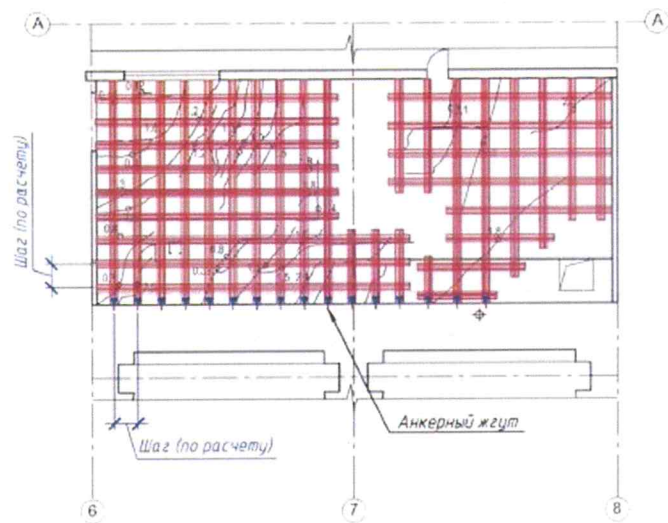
Усиление перекрытия щитового отделения здания ГЭС
